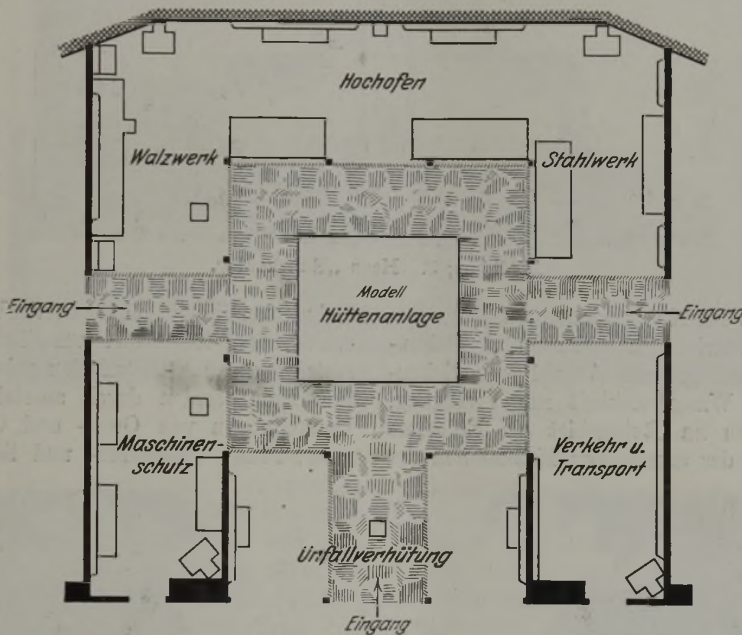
Grundriß der Ausstellungshalle Abb. 1.
